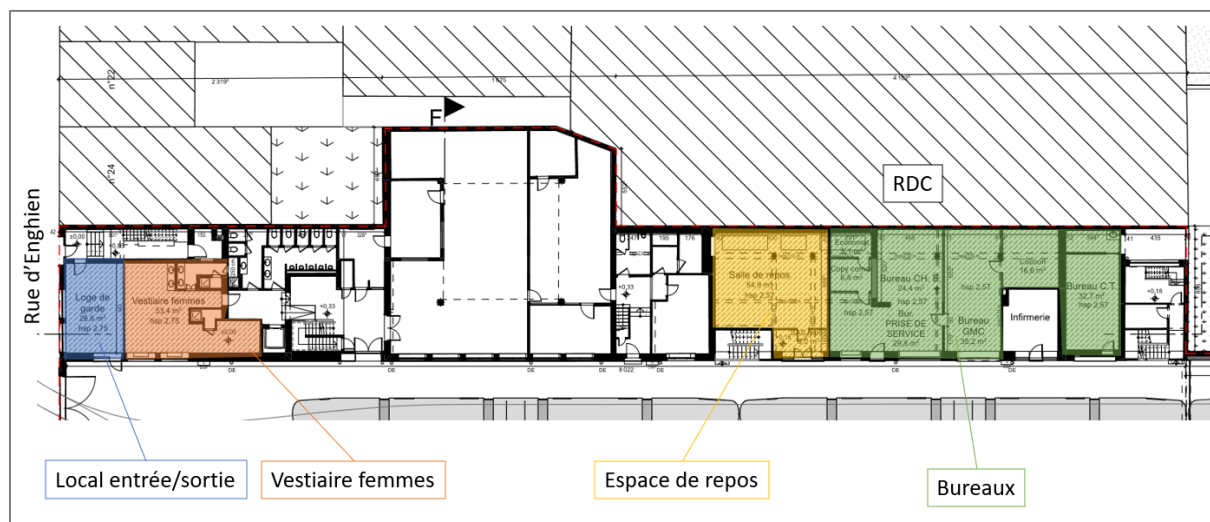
Plan des nouvelles affectations au niveau du bâtiment administratif - RDC (source : Architecte)
